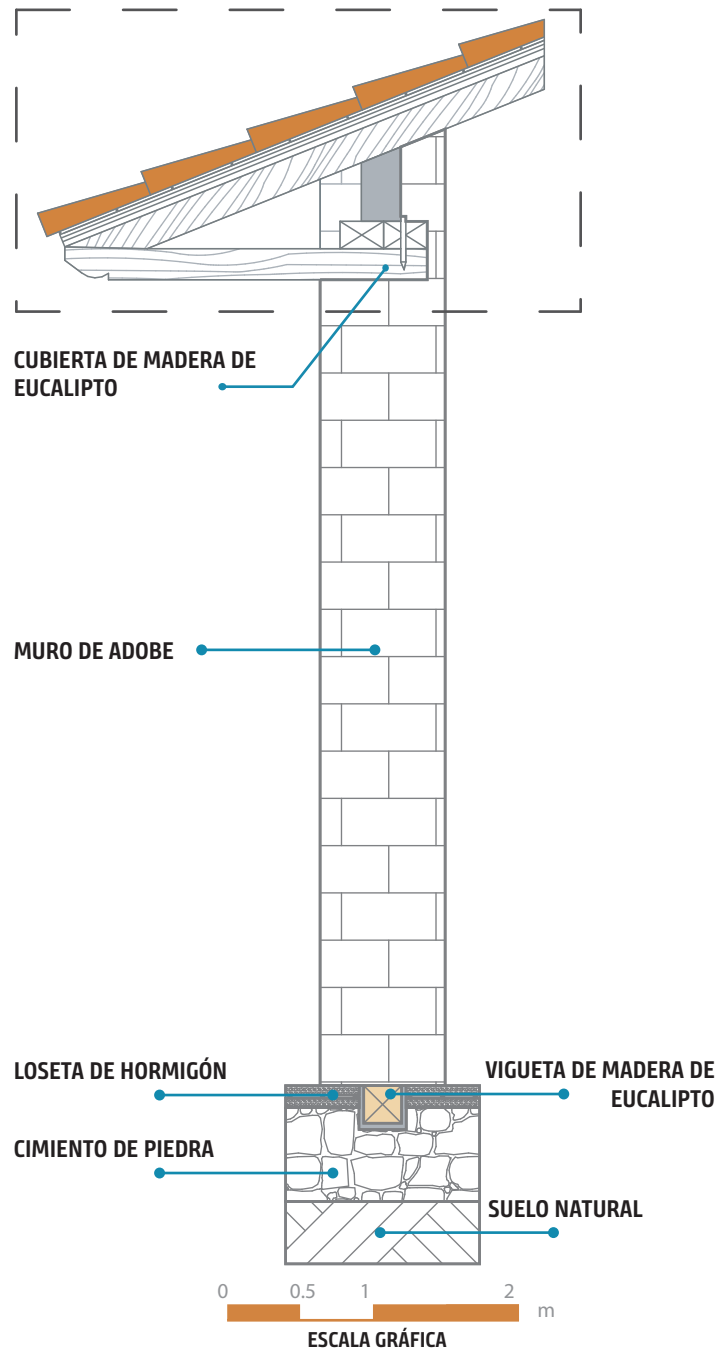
Sistema constructivo de la casa Jesús Arriaga, Fuente: Elaboración propia
